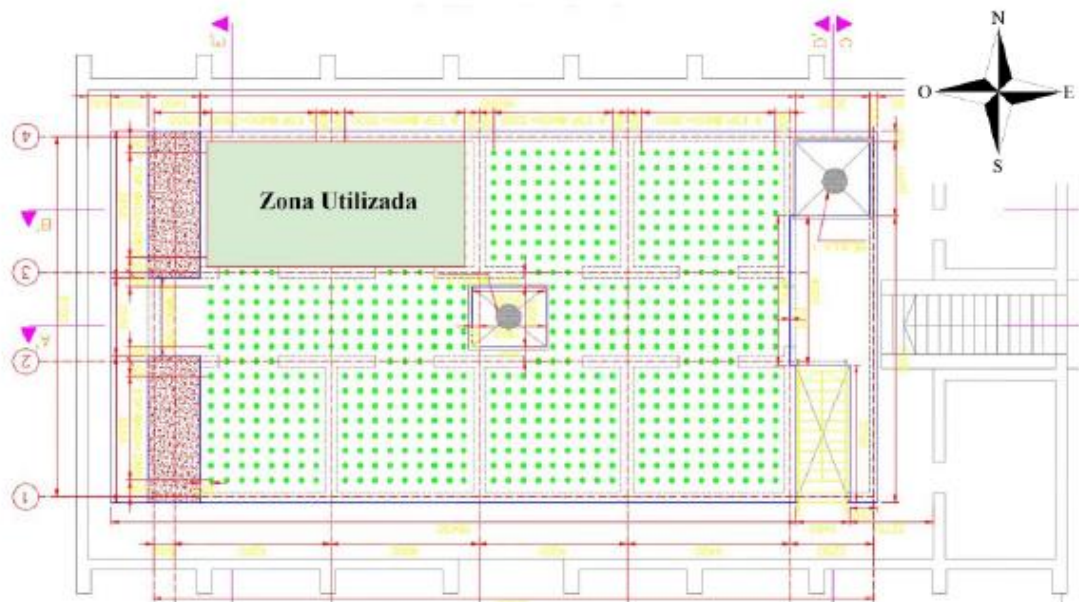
Plano en planta del laboratorio Arturo Arias
